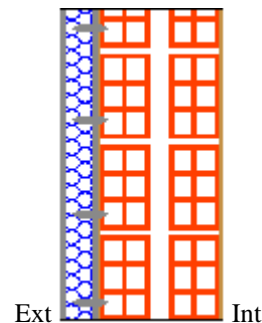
Solução Fach. 4 - Componentes prefabricados constituídos por um isolante e um paramento, fixados diretamente à parede
